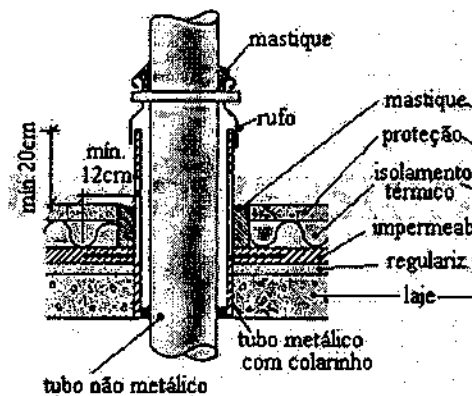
Utilização de mastique para preenchimento de junta. Disponível em: http://www.npc.ufsc.br/gda/humberto/Aula_impermeabilizacao.pdf
